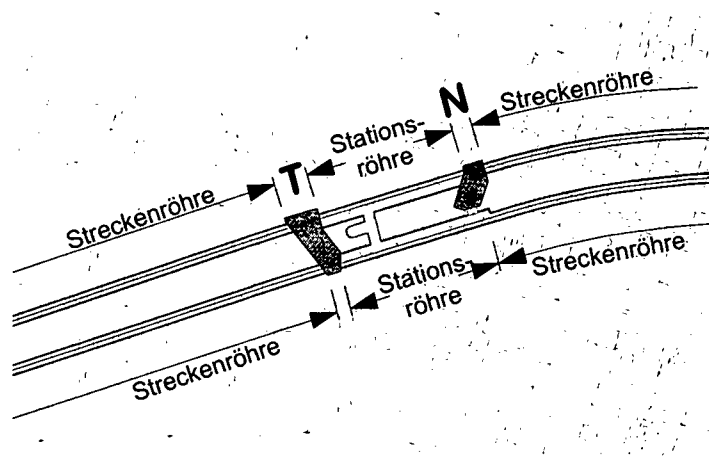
Ausschnitt aus dem Lageplan des Bauloses U2/2 mit den Stationsbauwerken T und N sowie den beiden Stationsröhren.
